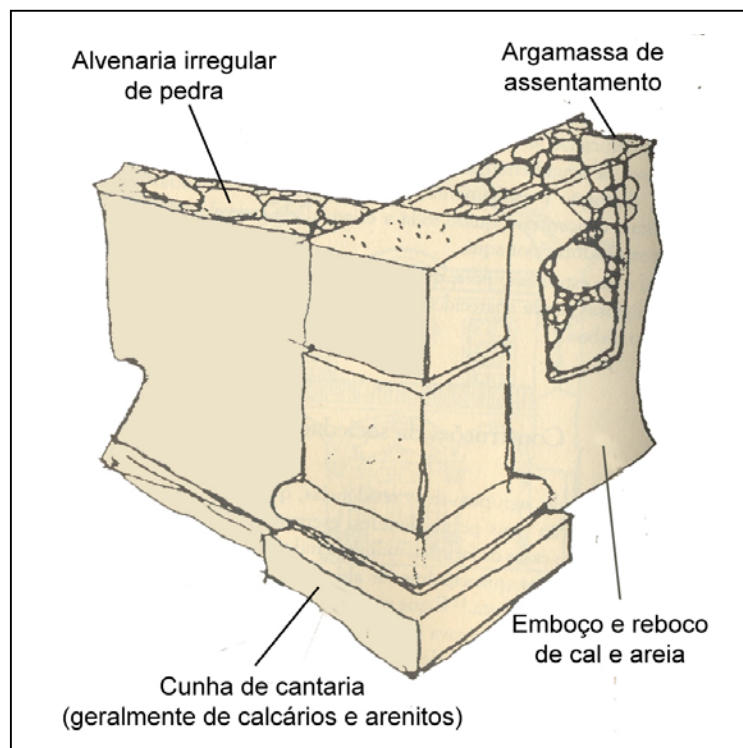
Detalhe de uma parede de pedra. (Fonte: VARGAS, 1994)
